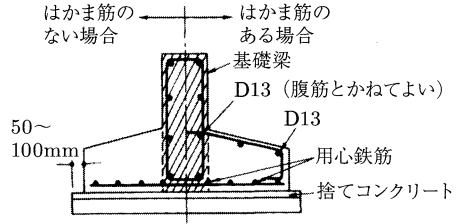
連続基礎の配筋 (RC 造配筋指針)
